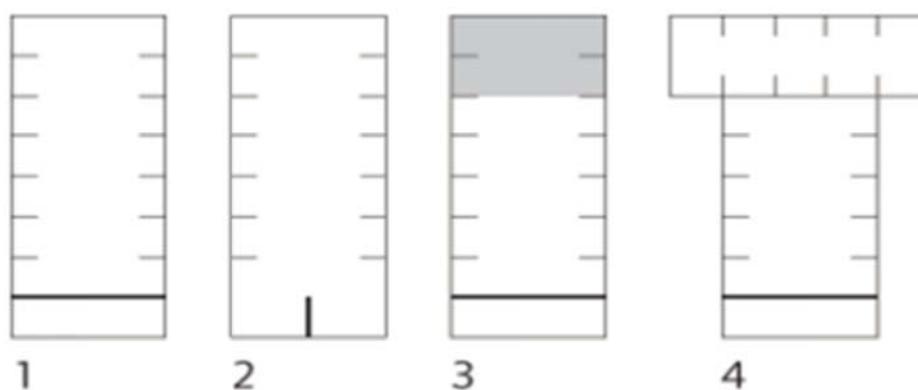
Схемы композитных балок: а – армирующая пластина по горизонтали; б – вертикальная армирующая пластина; в – армирующая пластина в растянутой зоне сечения; г – поперечное сечение тавровой балки с усилением растянутой зоны
